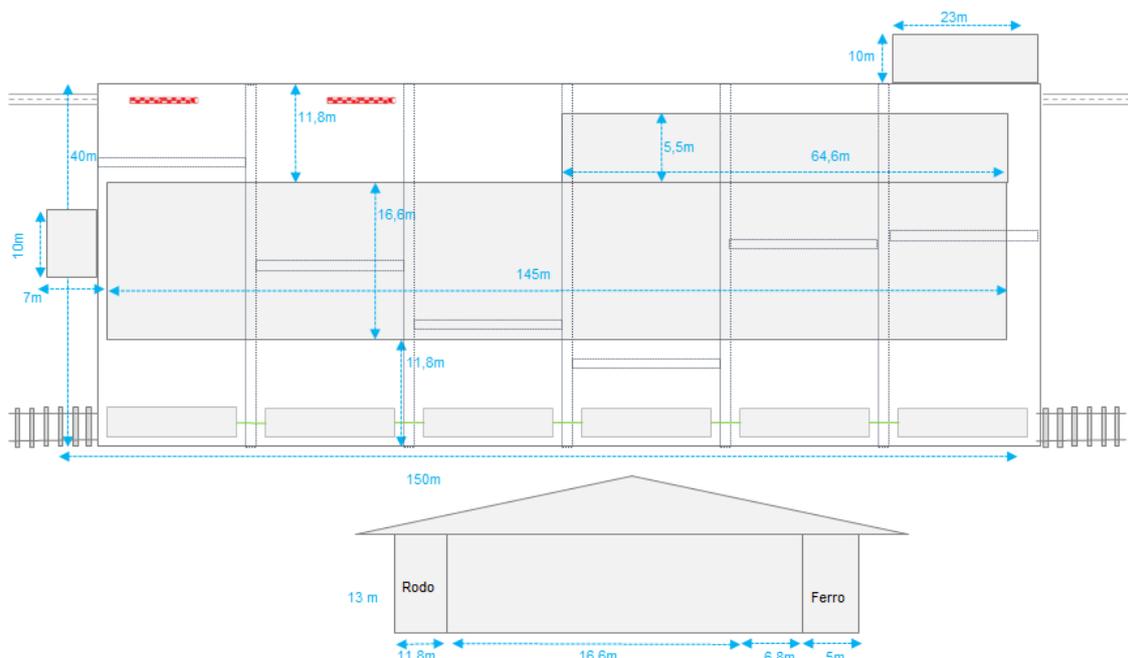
LAYOUT DO ARMAZÉM COM PONTE ROLANTE
